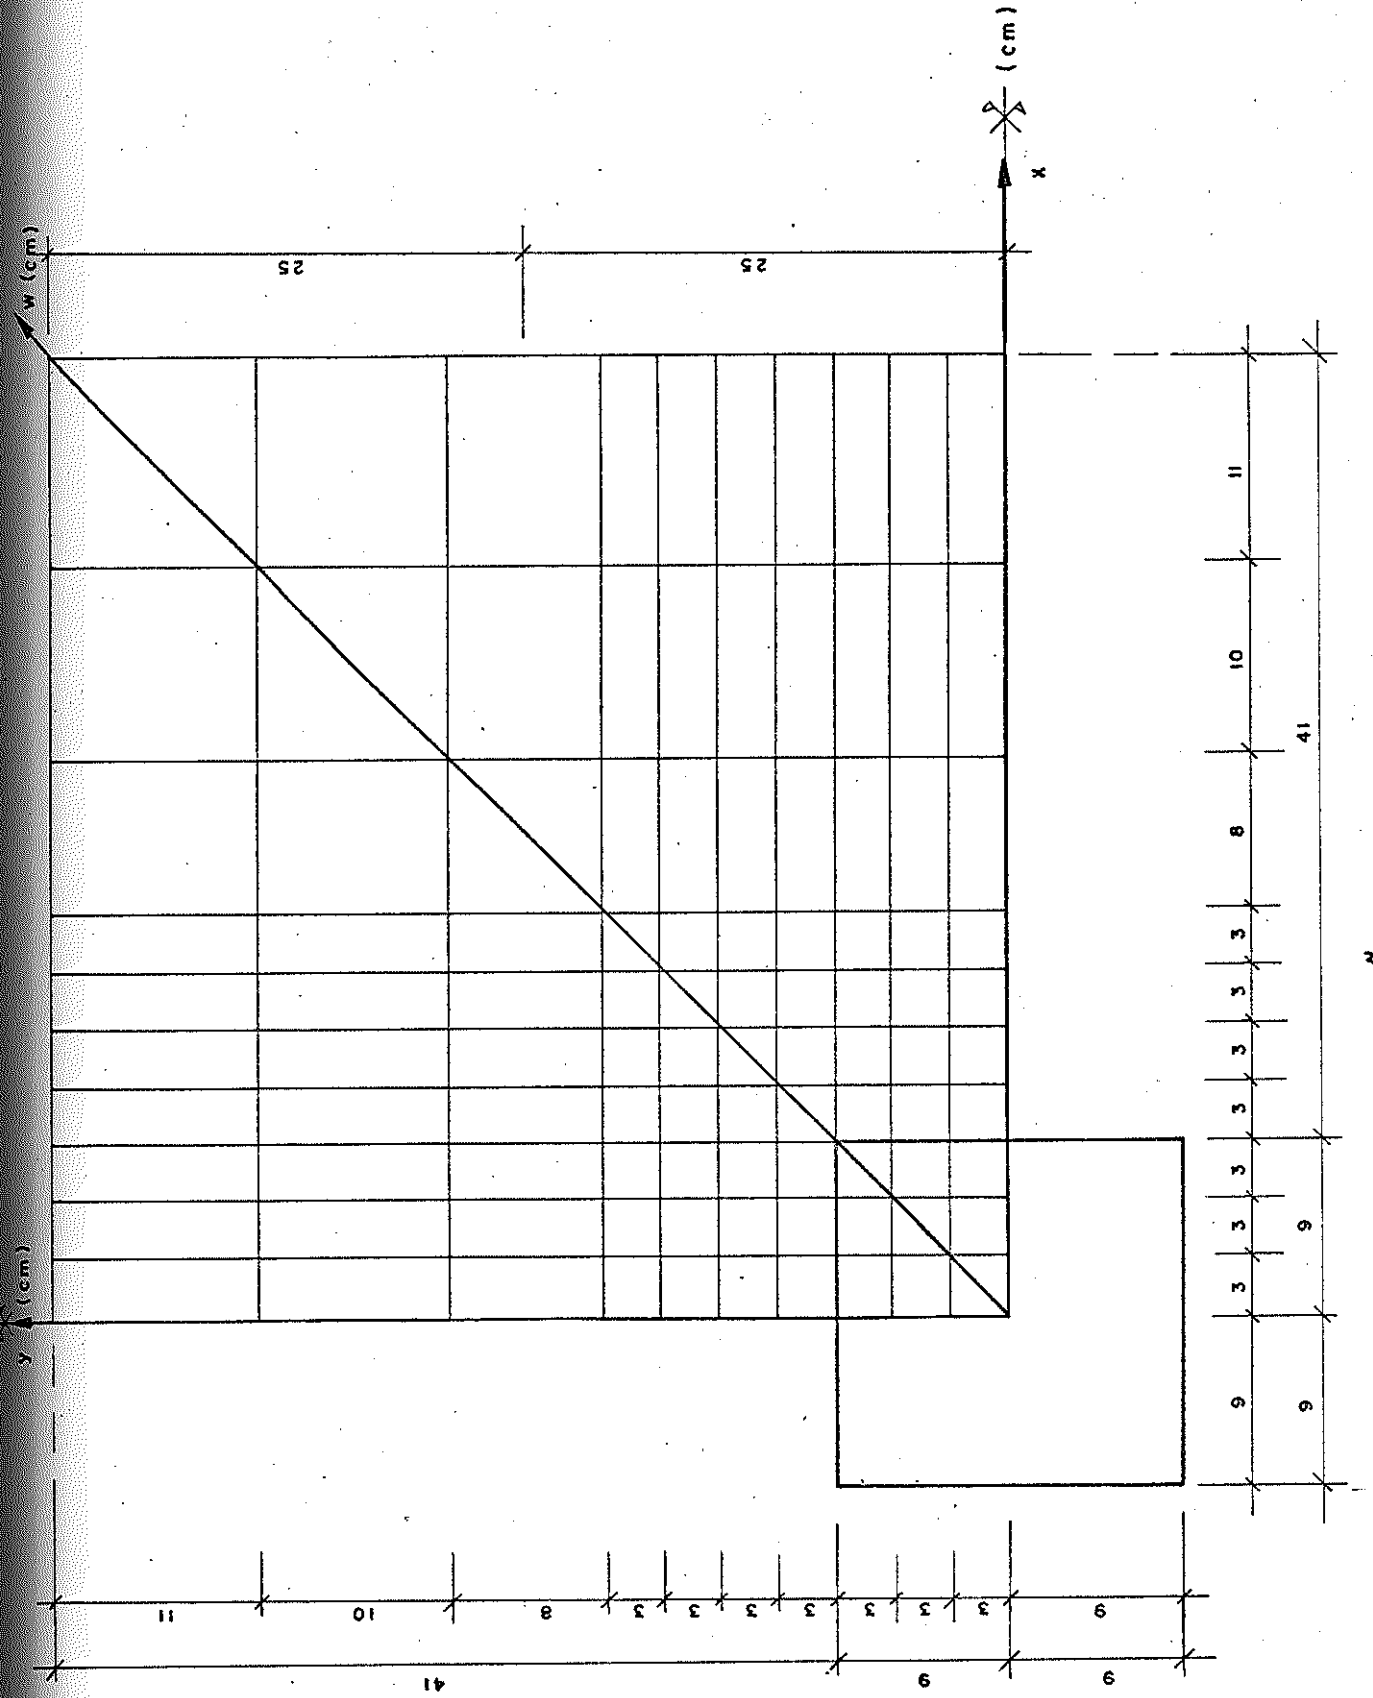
DISPOSIÇÃO DOS ELEMENTOS EM PLANTA
